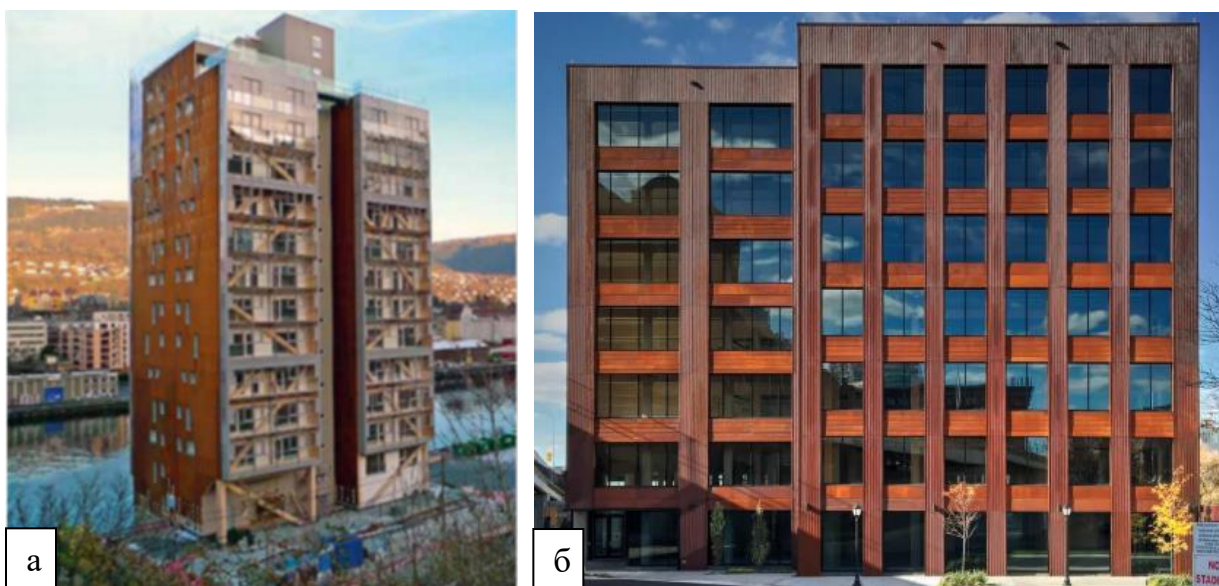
Примеры строительства многоэтажных зданий из ДКК: а – Жилой дом в Бергене, Норвегия (2015) [156]; б – Офисное здание в Миннеаполисе, США (2016) [158]
